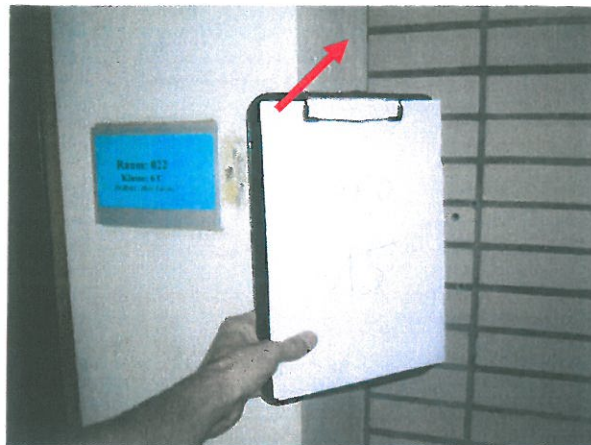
Betonstutzendichtung, Flur vor Raum 22
